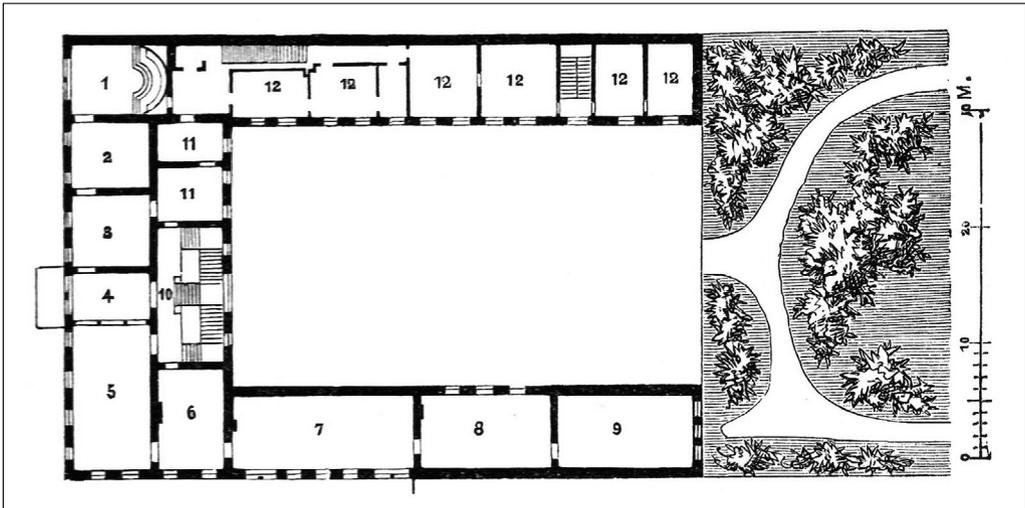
Grundriss der 1. Etage im Palais Redern.
